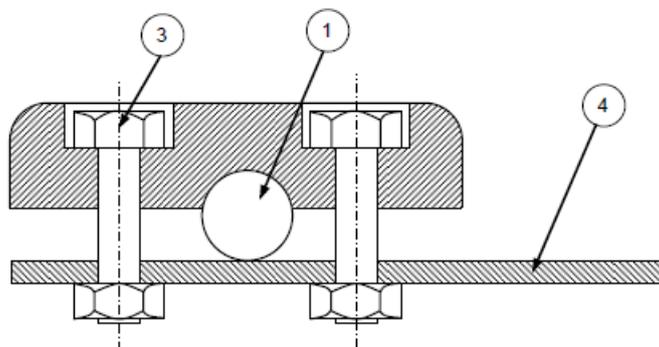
Connessione di un conduttore a nastro ad un ferro d'armatura
